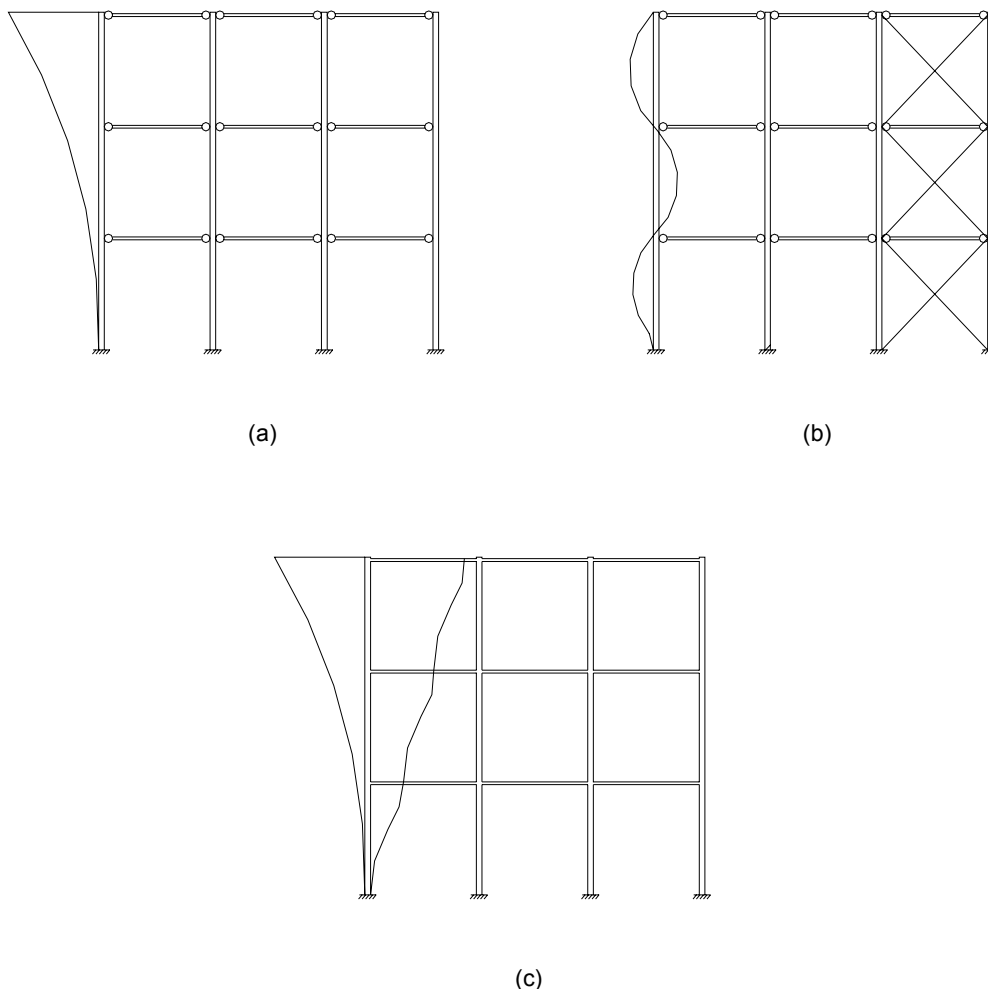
Entramado articulado, articulado-arriostrado y rigido
